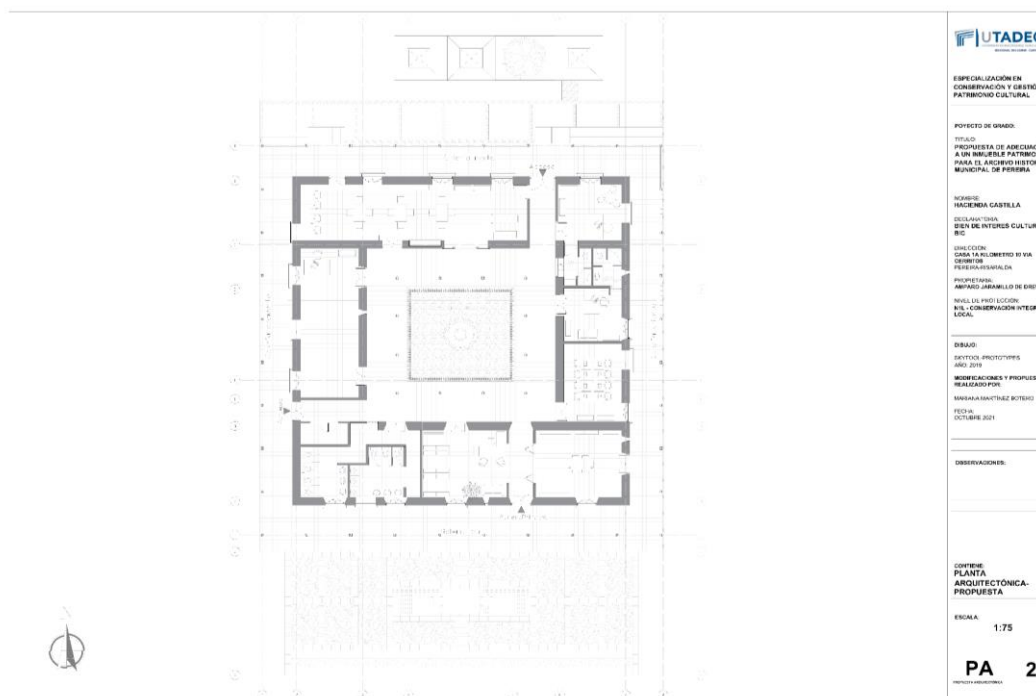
Propuesta Arquitectónica- Planta casa principal. Fuente: Propia
